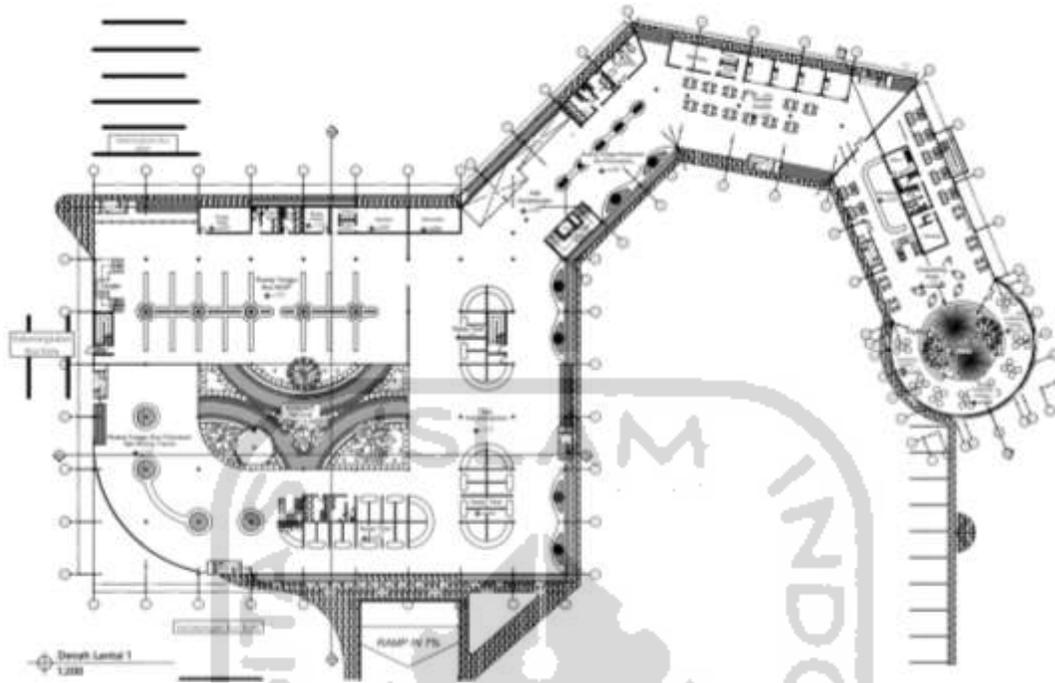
gambar teknis lantai 1 dan mikro siteplan (sumber: penulis, 2020)
